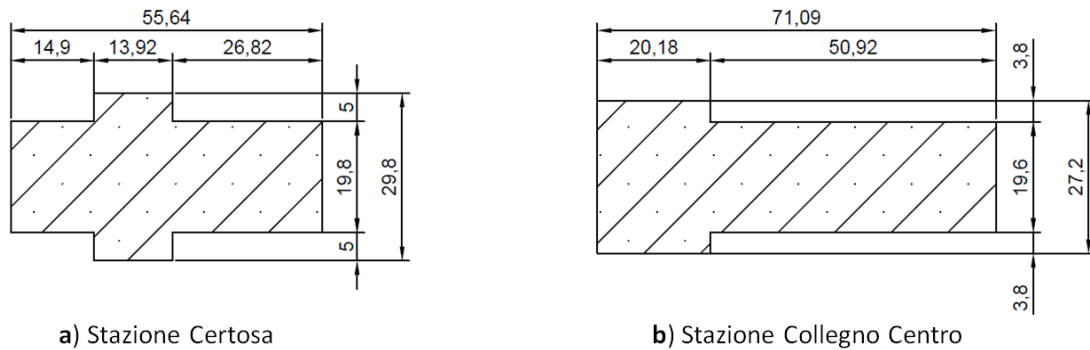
Sezione in pianta della stazione Certosa (a) e Collegno Centro (b).
